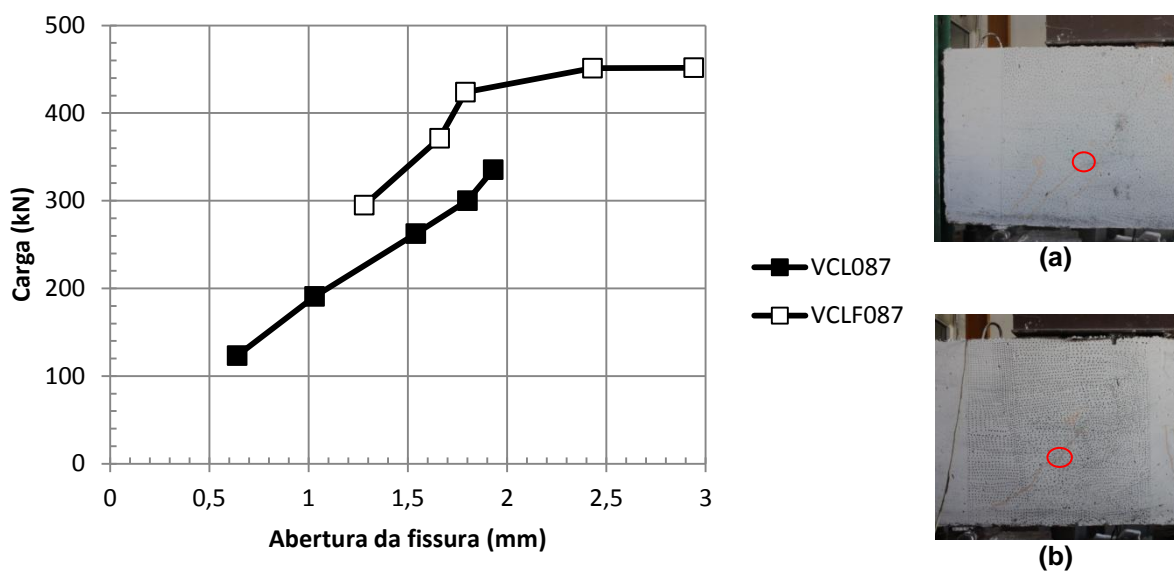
Evolução da abertura de fissuras nas vigas-parede: a) VCL087 e b) VCLF087.
